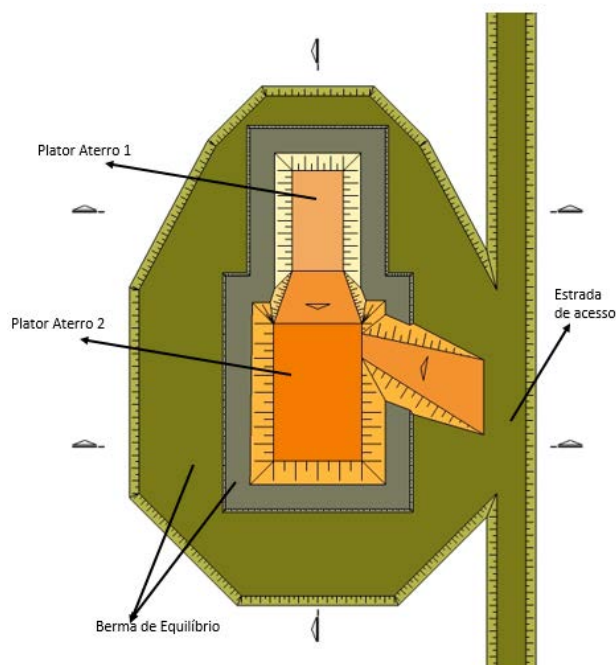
Layout do projeto do aterro experimental com as bermas de equilíbrio.
